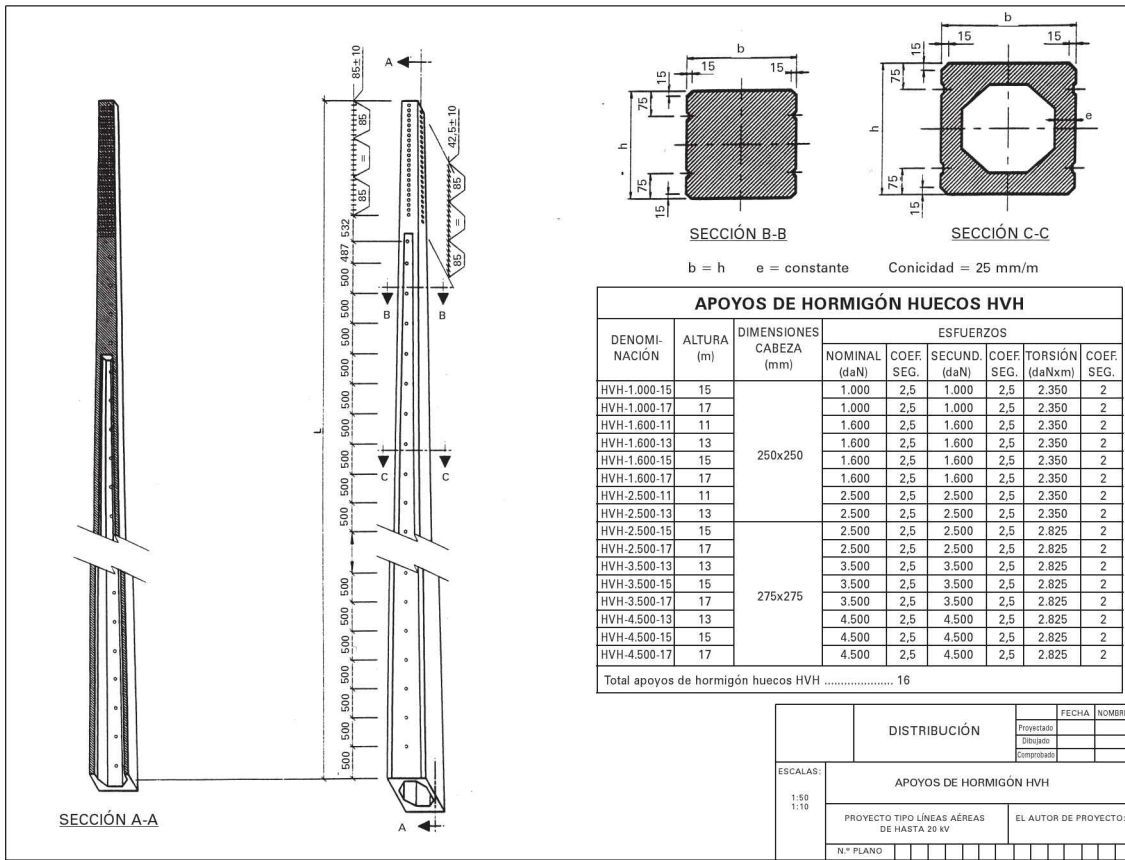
Apoyos de hormigón armado vibrado huecos HVH.
